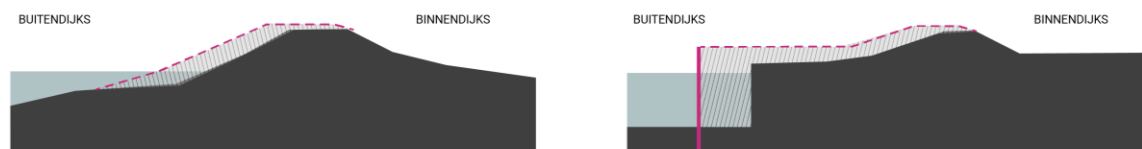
Algemene dwarsprofielen voor de kansrijke alternatieven (nog zonder piping- of stabiliteitsberm)
